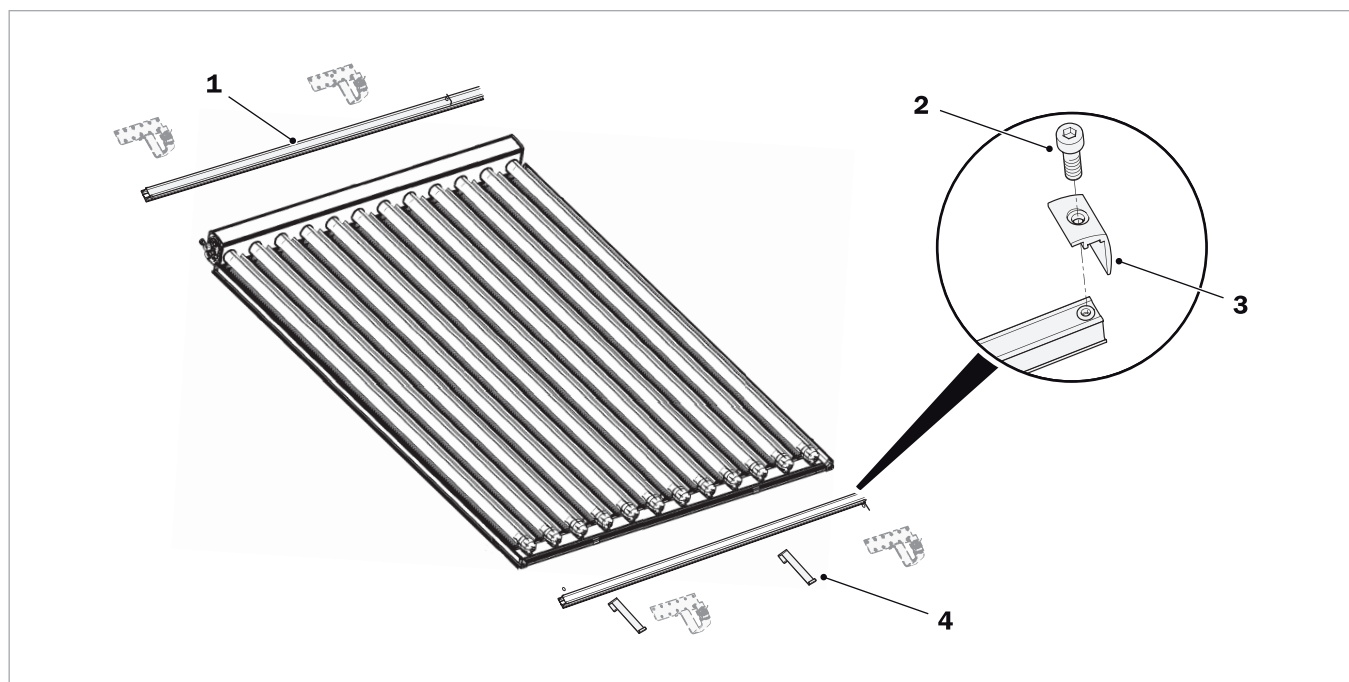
kit de rails pour montage par surimposition de SolvisLuna (capteur et fixation sur toiture non inclus dans la livraison)
